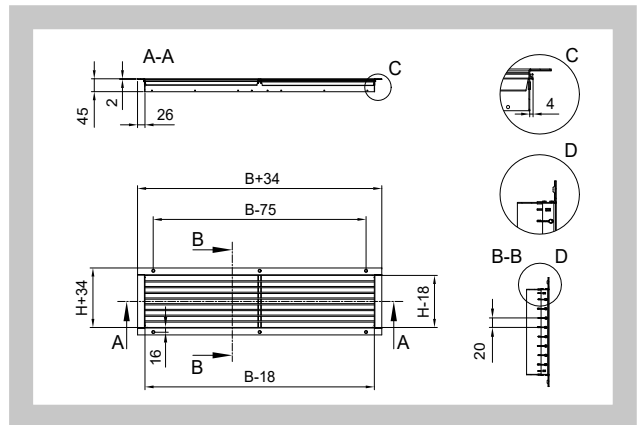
Einstellbare Lamellen vertikal - einreihig
